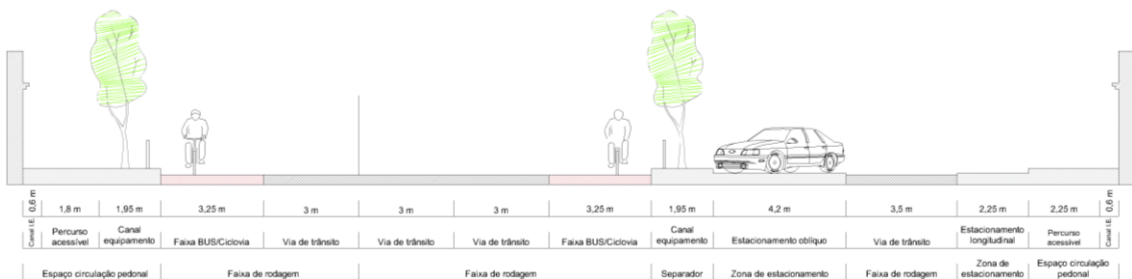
SECÇÃO PROPOSTA M-M'
